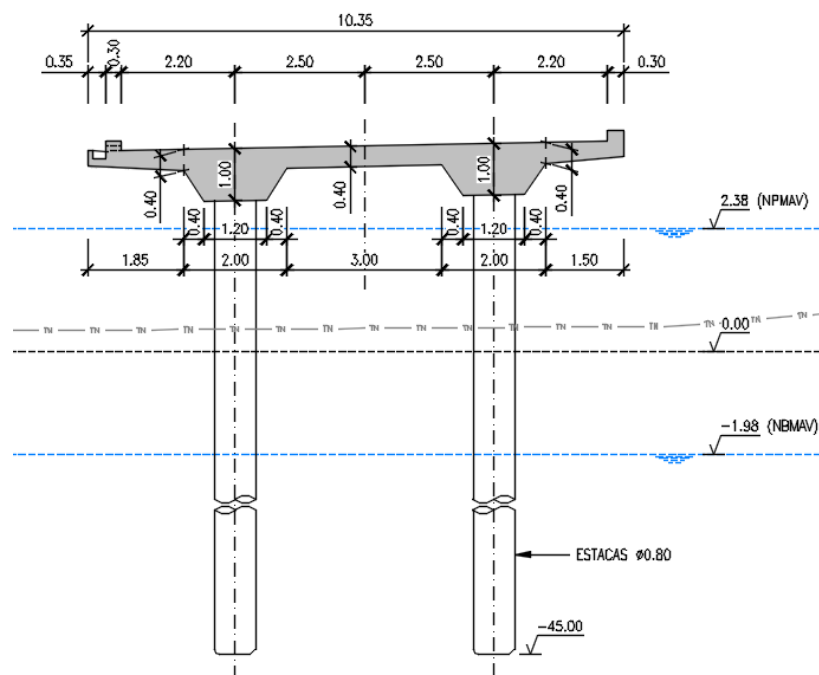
Secção tipo da ponte de acesso (Fonte: Projeto de Execução).
